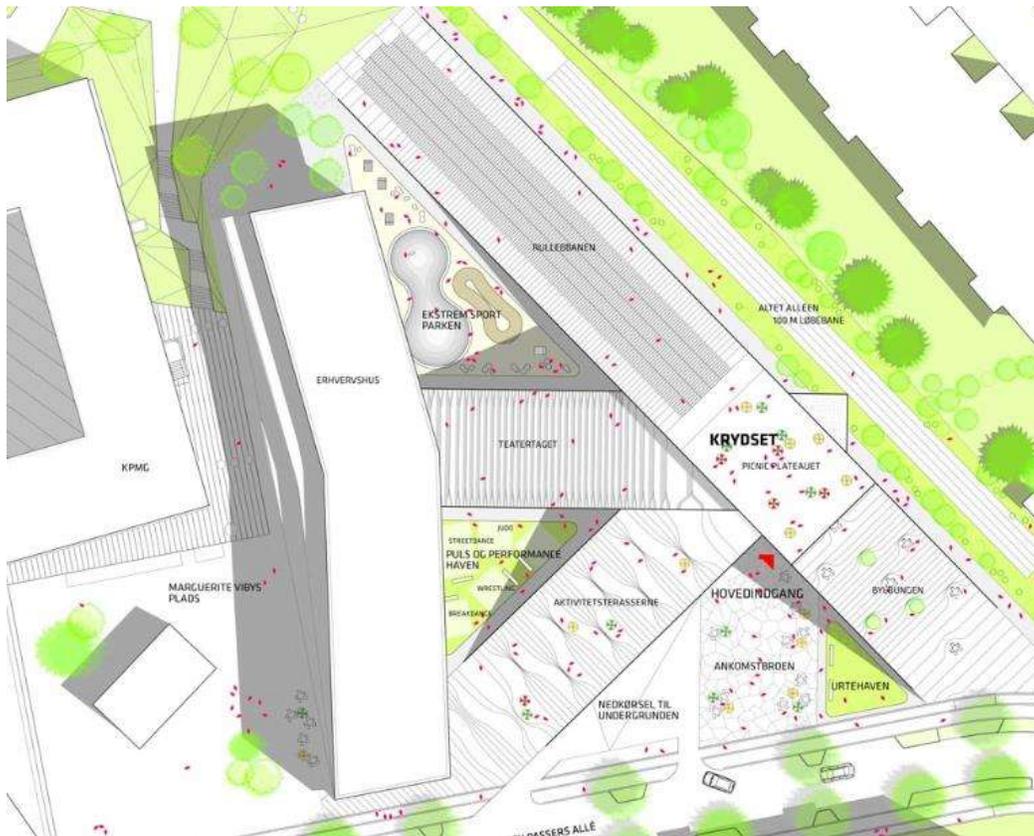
Planta de Conjunto del Centro Cultural en Dinamarca. ArchDaily.
